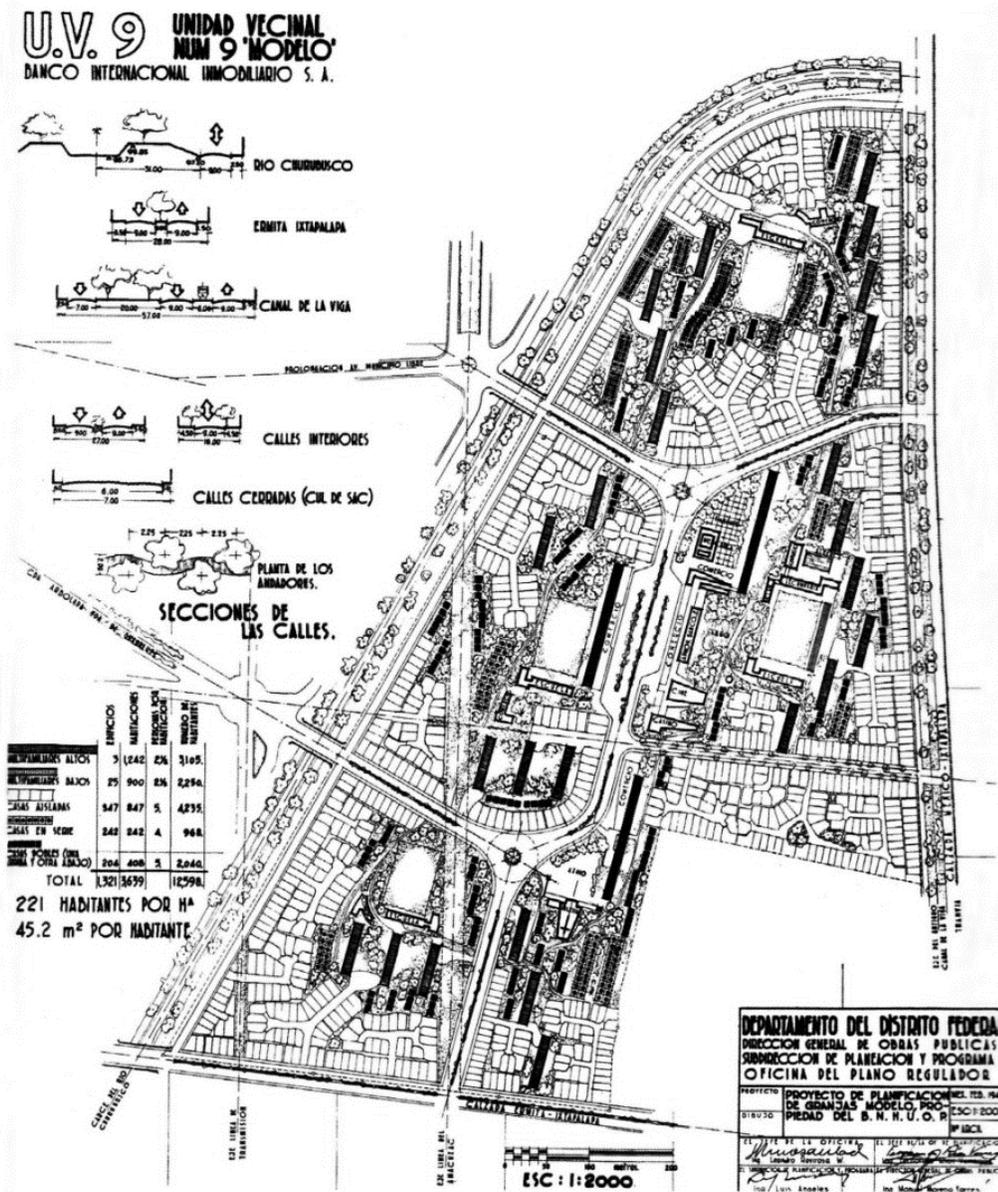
Plano de conjunto de la Unidad Modelo.
